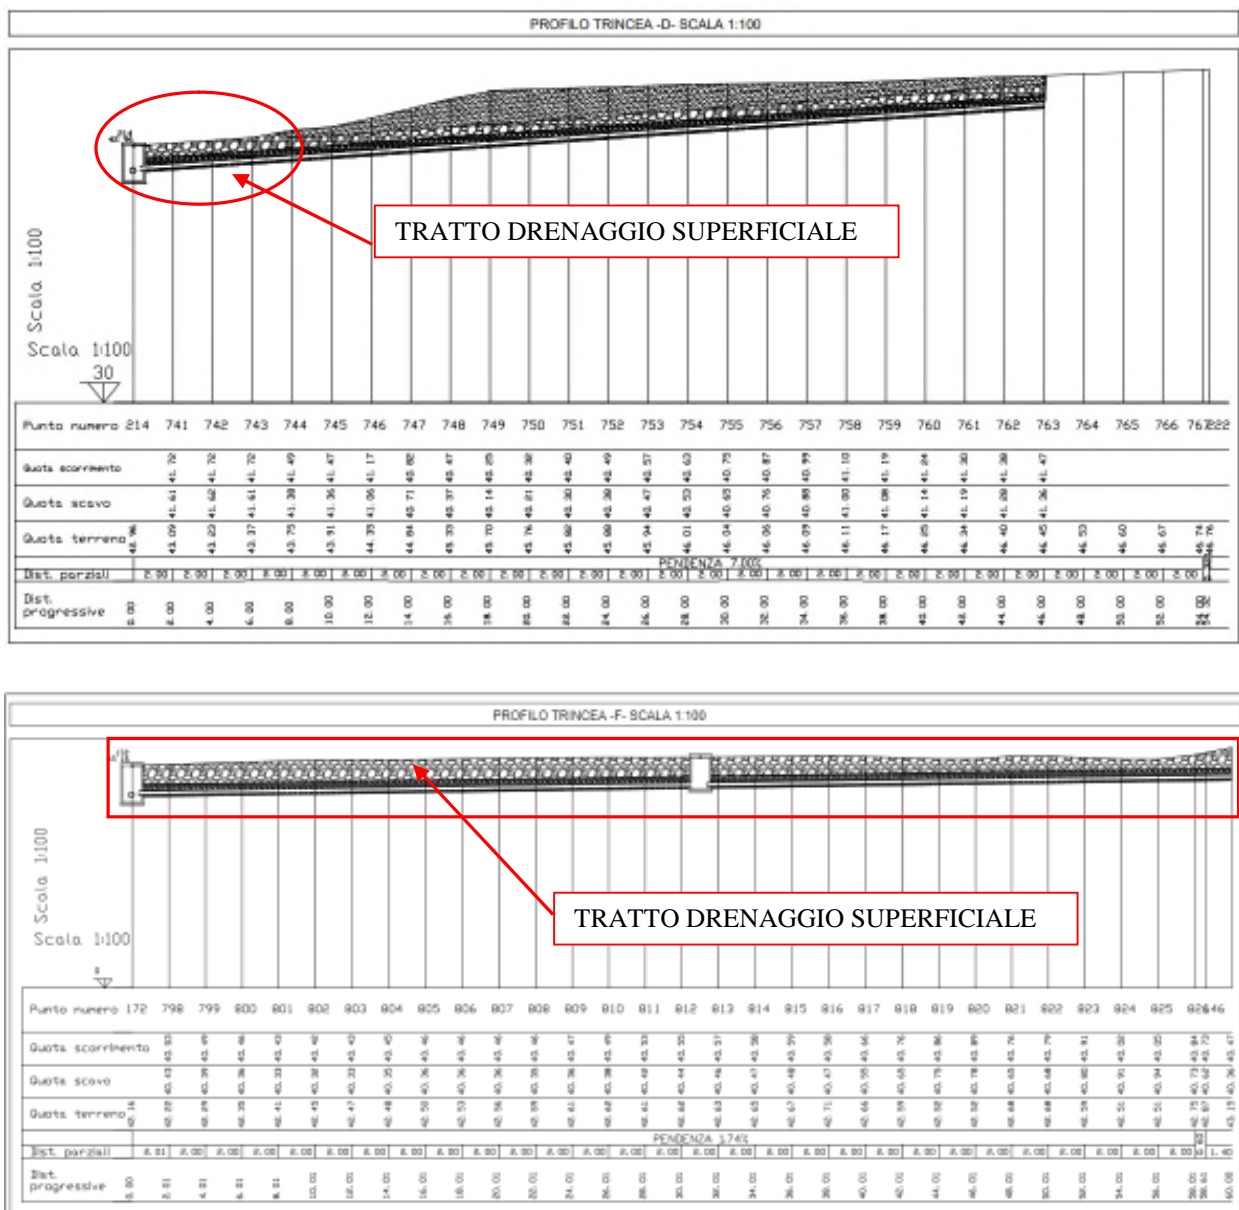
PROFILI TRINCEE DRENANTI
